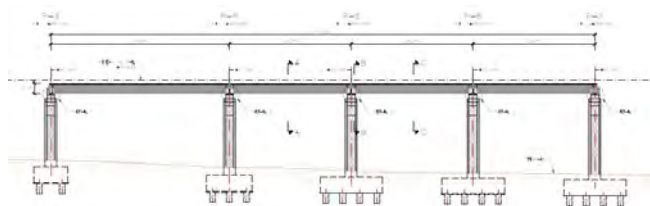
Planta y alzado de estación Ain Naadja Gare.
